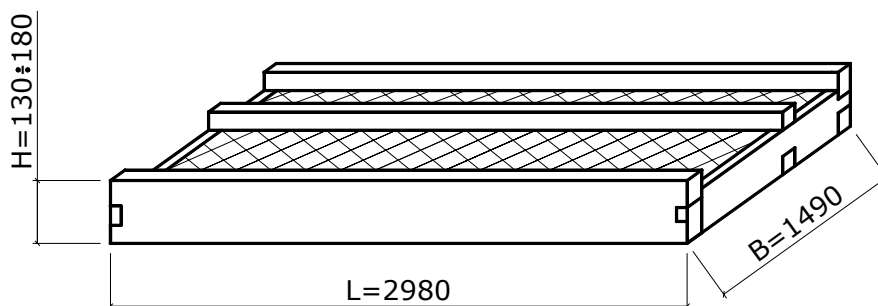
Плита на дерев'яному каркасі з обшивкою з ДВП для улаштування на прогонах
